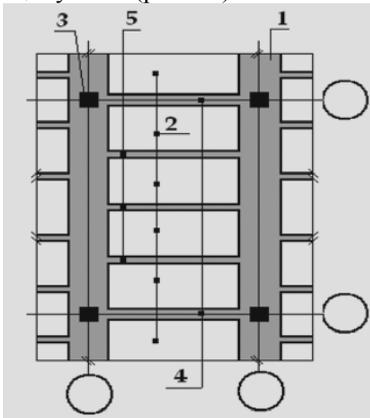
Стык колонны с Delta-ригелем и плитами перекрытия
